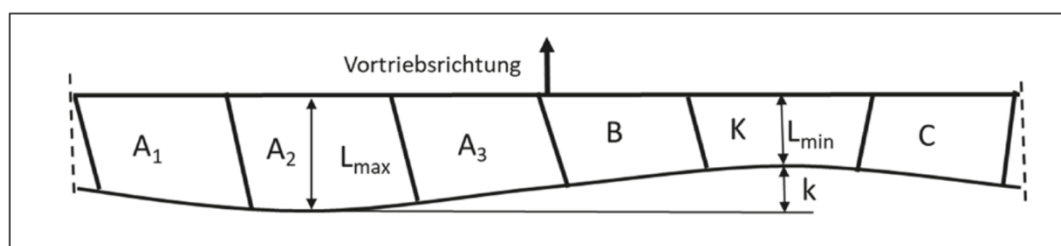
Prinzipskizze eines Universalrings mit schrägen Längsfugen [18]
